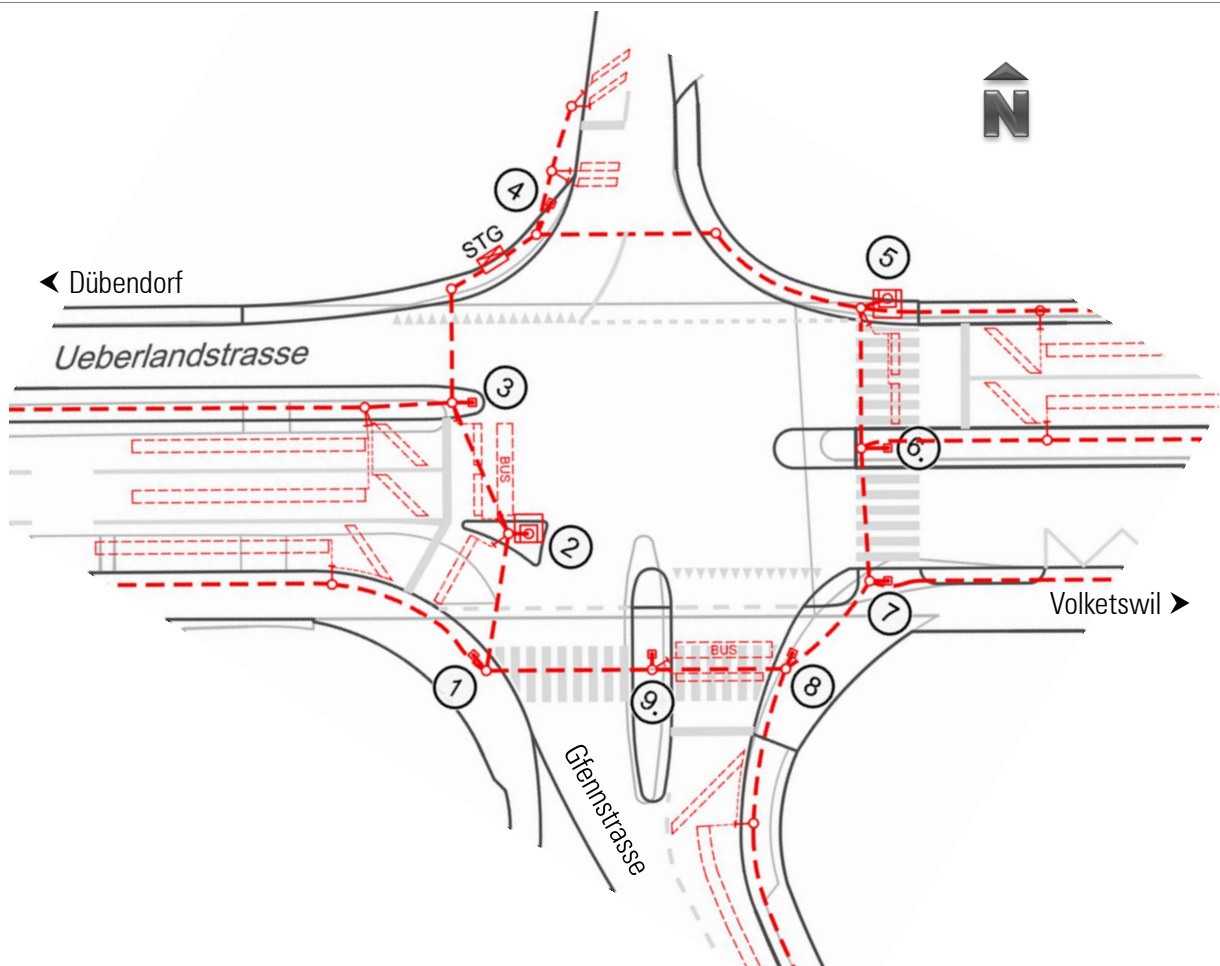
Ausschnitt Elektroplan LSA Ueberland-/ Gfennstrasse
